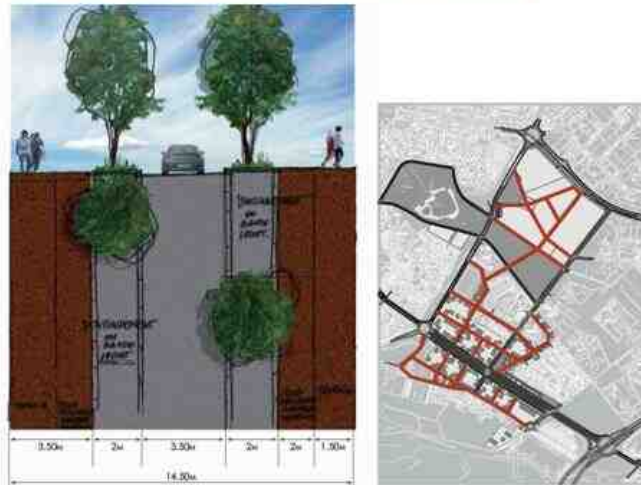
Profil en travers proposé au droit des futures voies internes du périmètre
